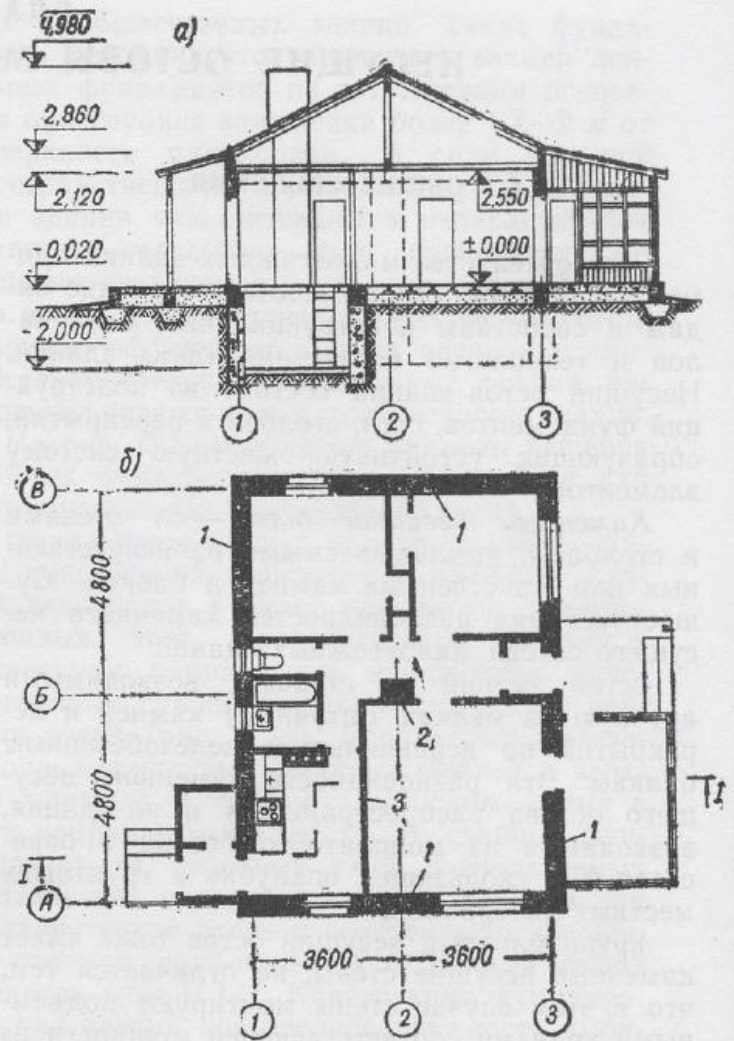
Малоэтажное каменное здание с неполным каркасом
